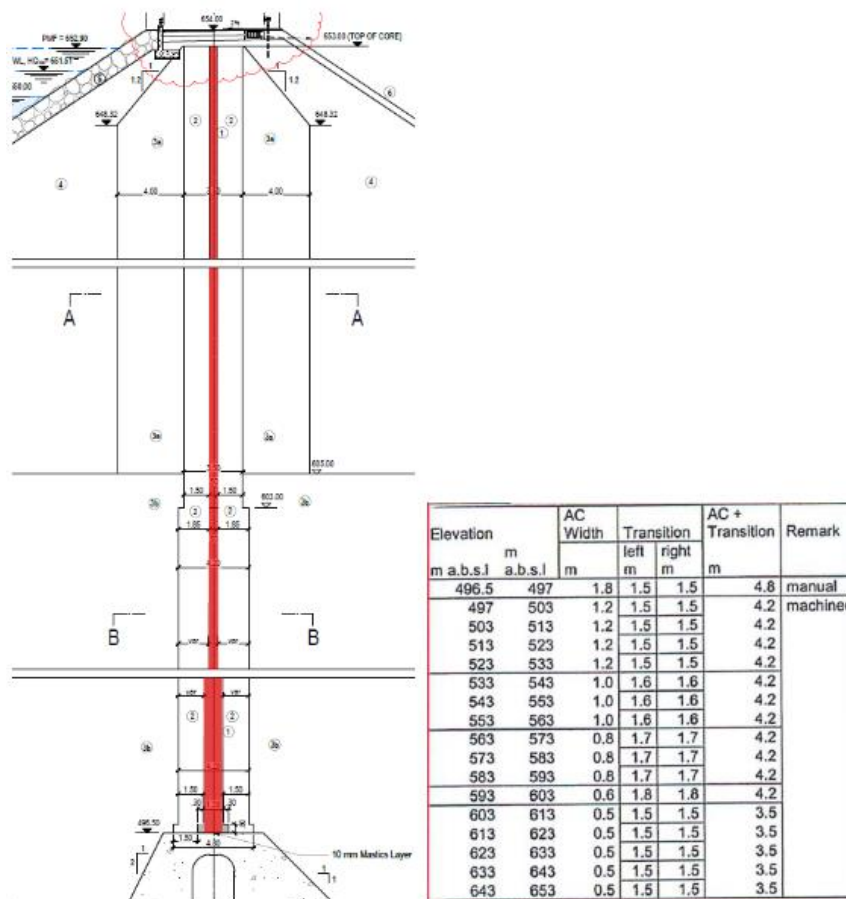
Secção Transversal através do Perfil do Núcleo Asfáltico (Statkraft, 2017)
